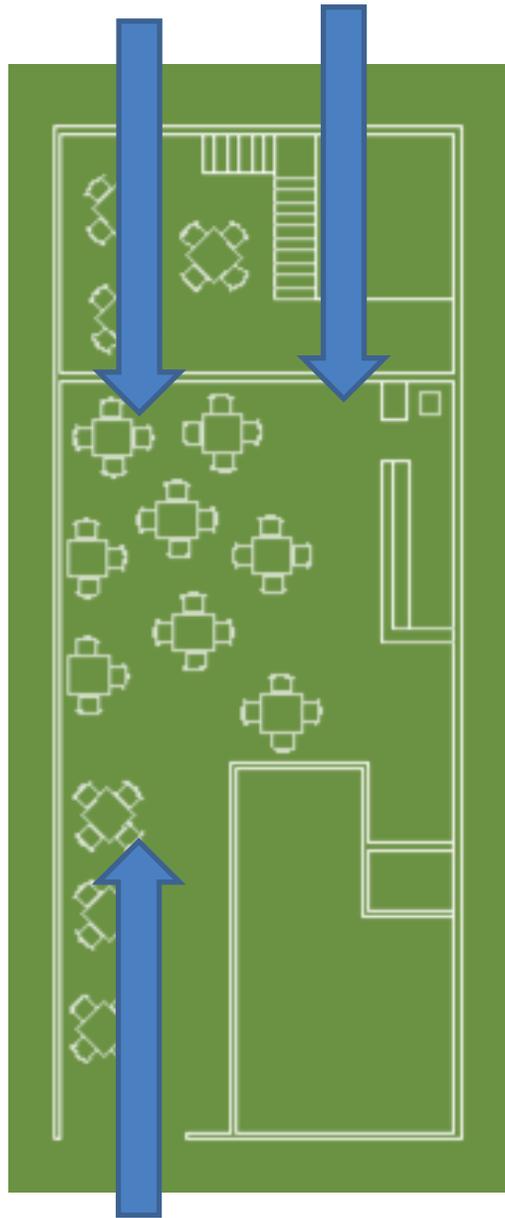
Planta arquitectónica señalando entradas de ventilación natural propuesta.
